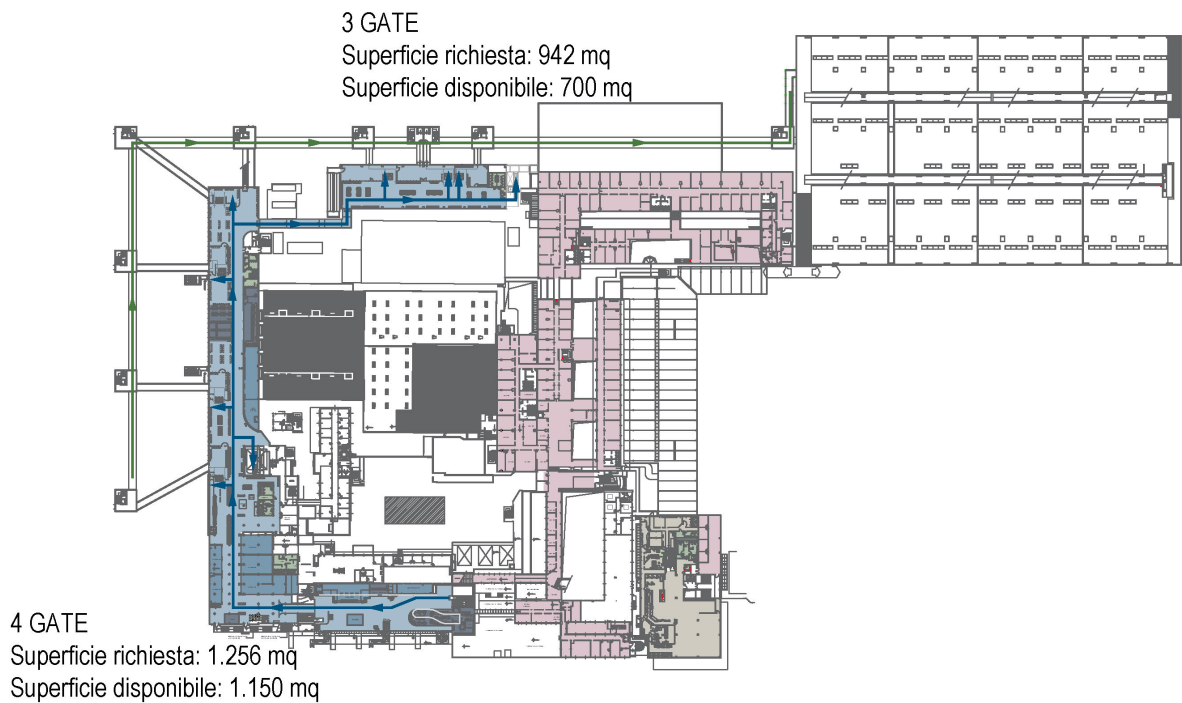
Aeroporto di Malpensa –Terminal 2 - piano primo - planimetria “stato di fatto”
